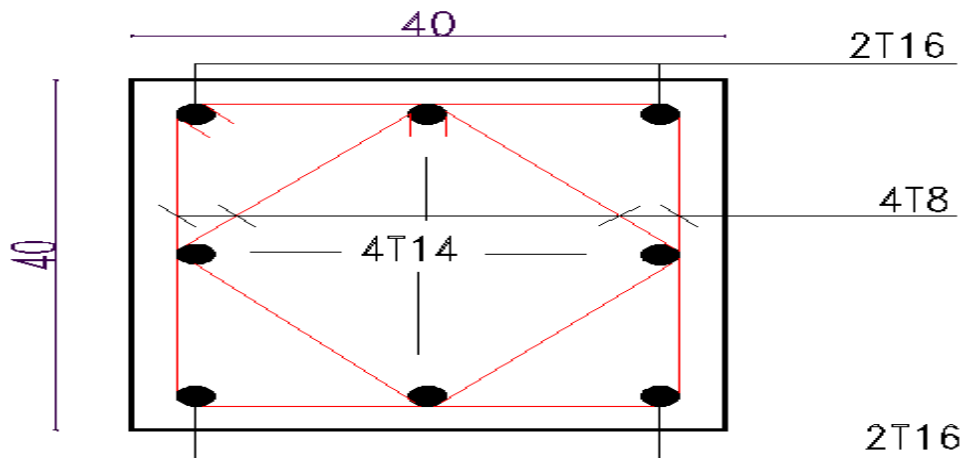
Schéma de ferrailage pour les poteaux 40×40.
